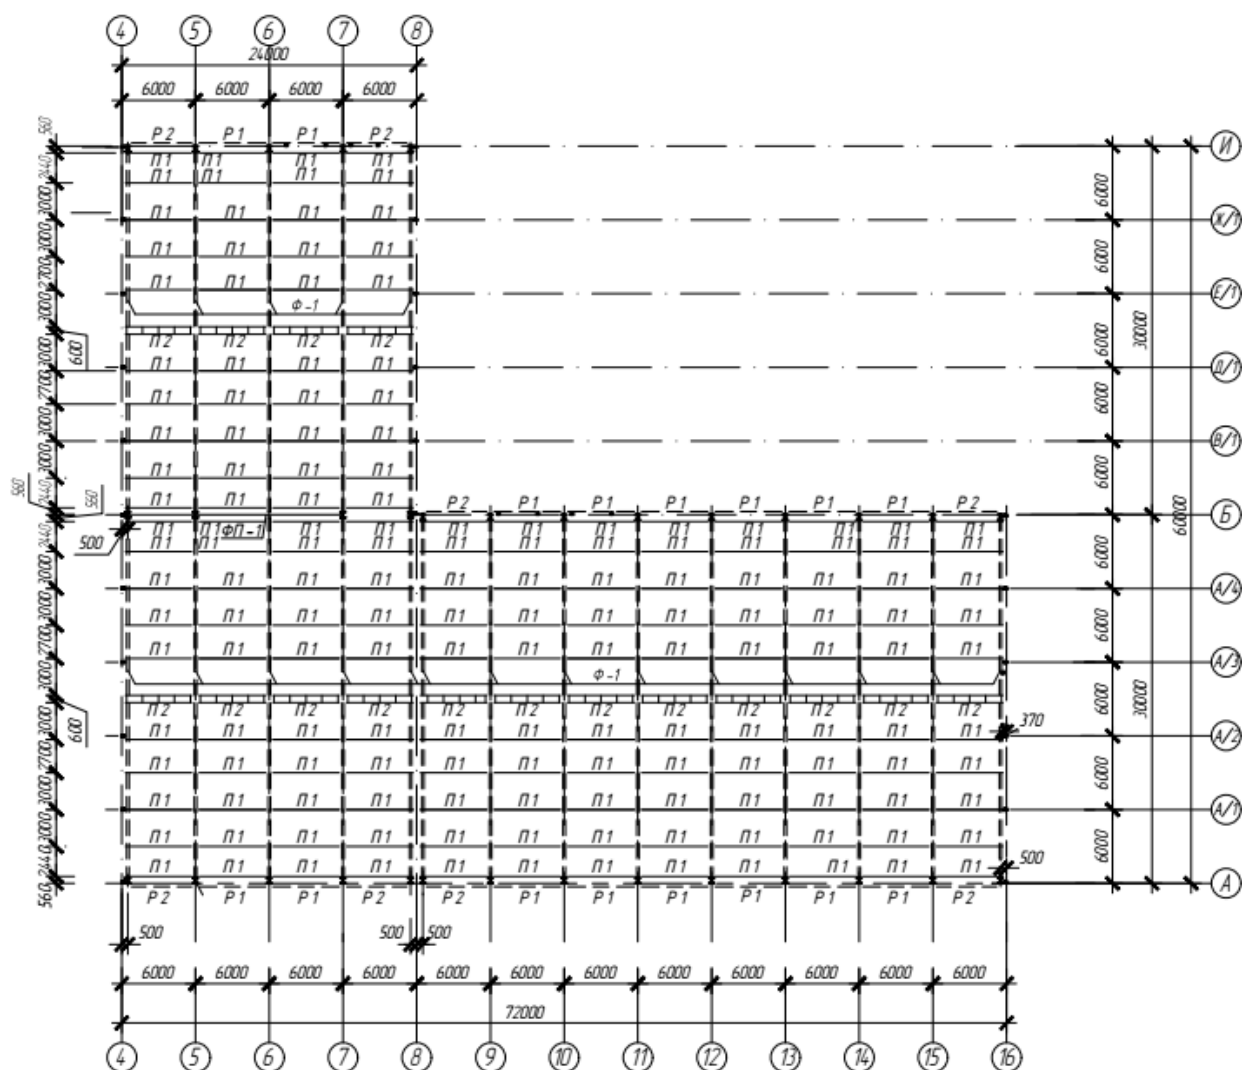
Схема расположения ферм, прогонов, горизонтальных связей и плит покрытия
